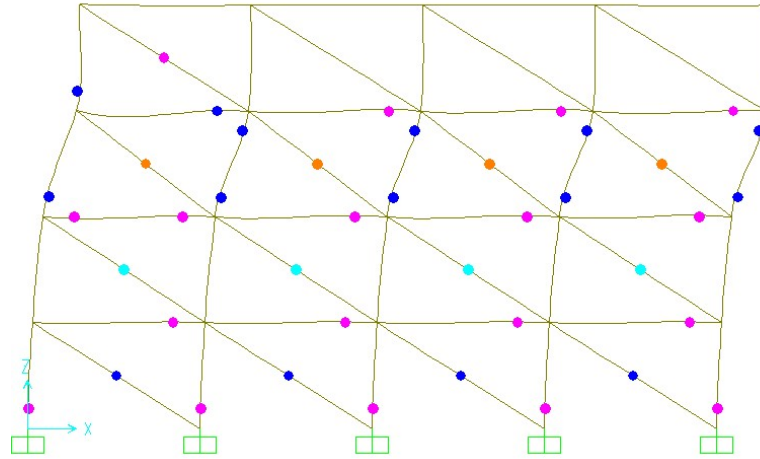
Mecanismo de falla en pórtico de hormigón armado del modelo 6-B.
